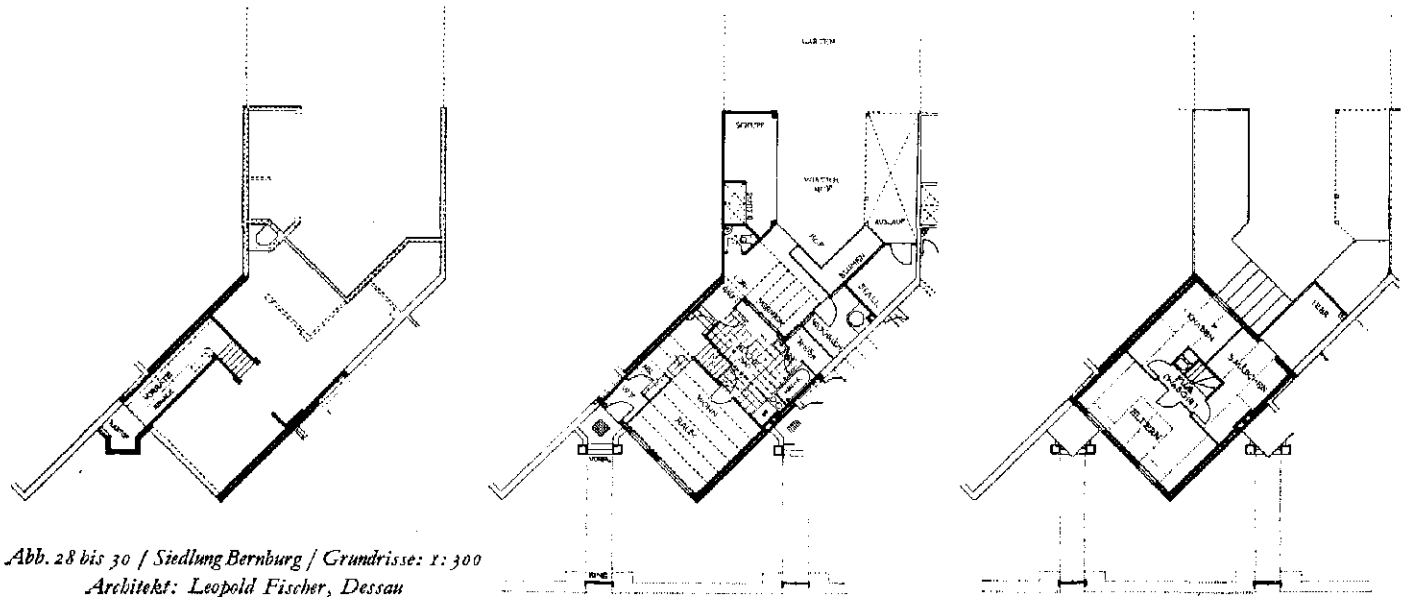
bis 30 / Siedlung Bernburg / Grundrisse: 1:300
